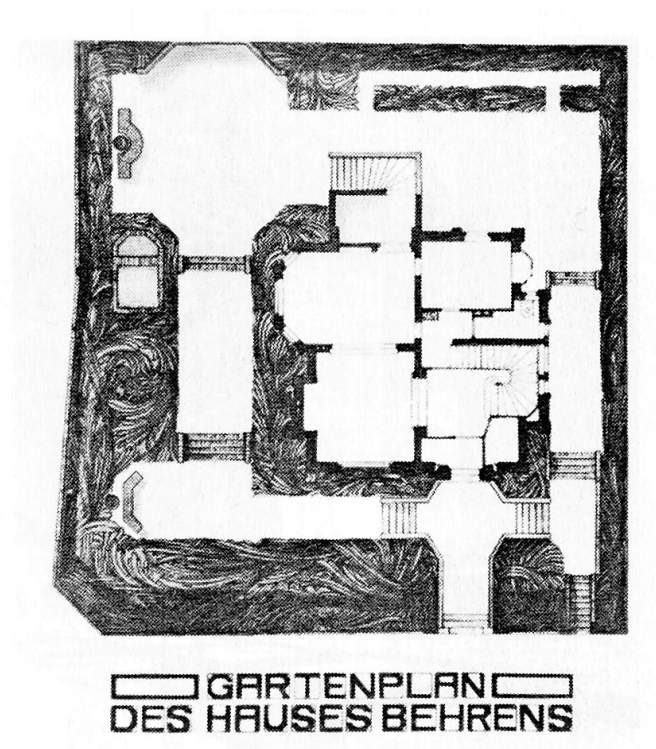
P. Behrens, *Haus Behrens*, *Grundriss EG mit Garten*, Darmstadt 1901
